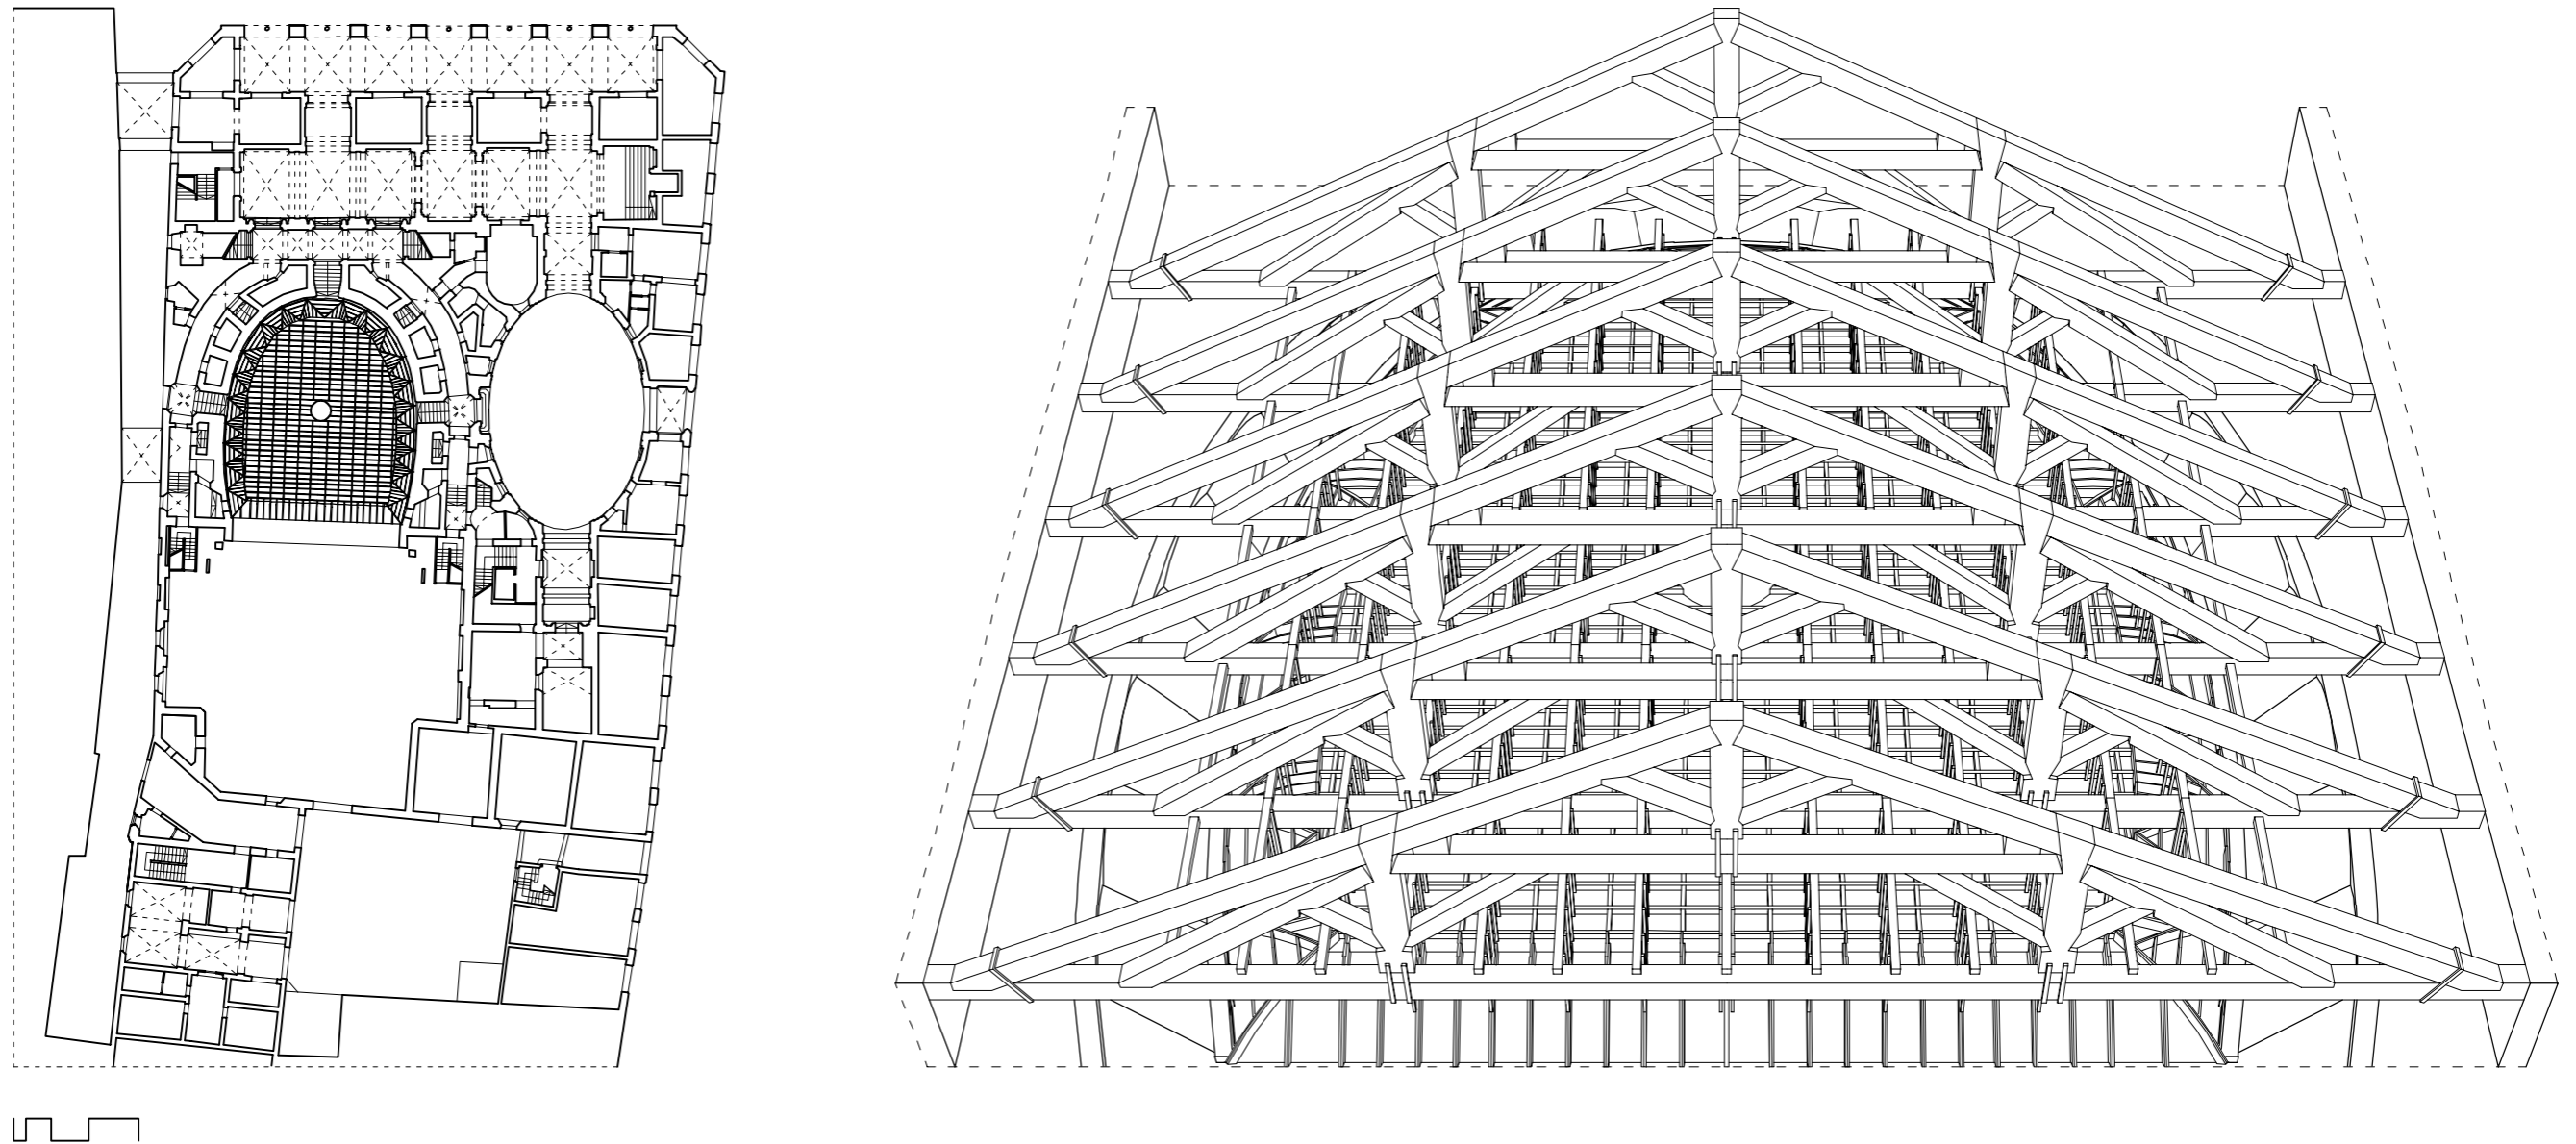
Teatro Comunale “Claudio Abbado” di Ferrara. Pianta del piano terra (ridisegno) con proiezione del plafone; rappresentazione prospettica del sistema di copertura della sala.
